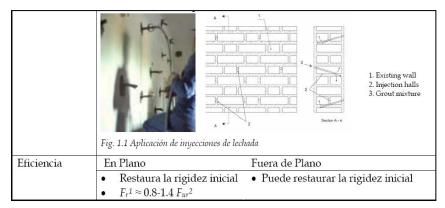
Esquema general de la aplicación de la lechada a una losa ó muro. Fuente: Articulo, una revisión crítica de los métodos de reforzamiento de estructuras de mampostería sin refuerzo
